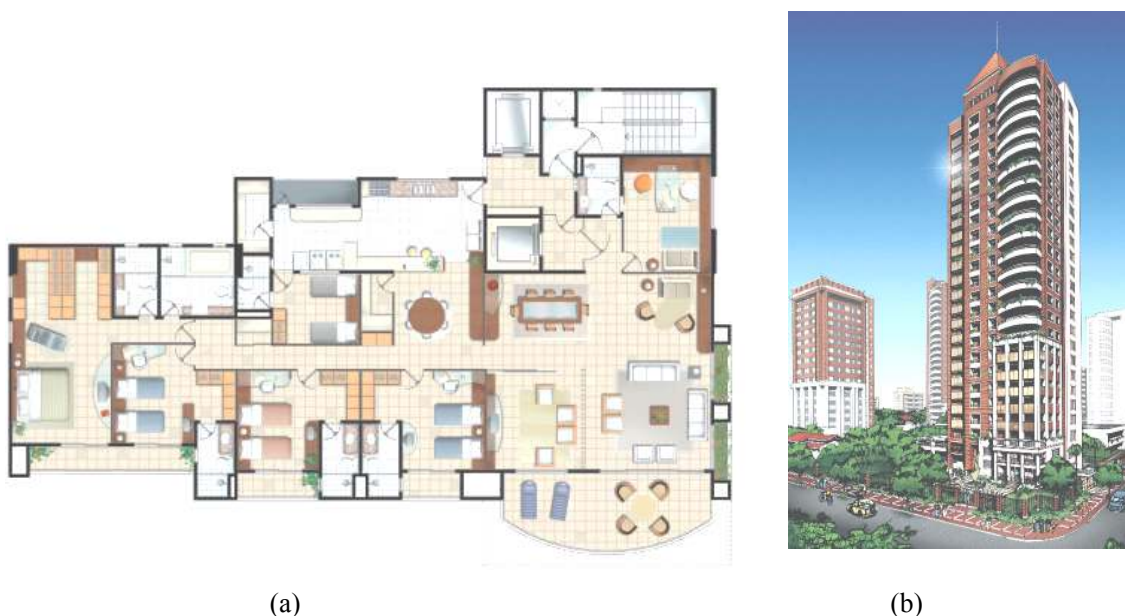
Planta baixa padrão do pavimento tipo (a) e vista da fachada do edifício (b).
